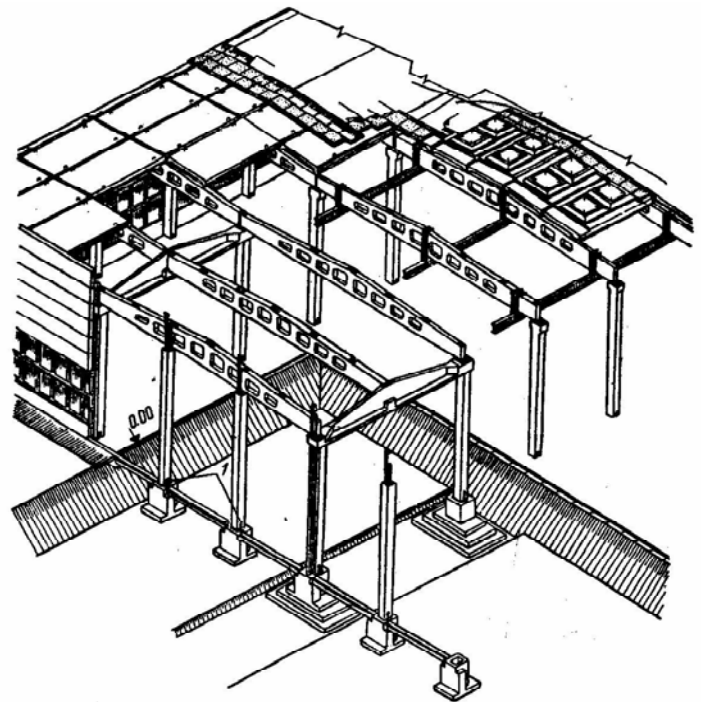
Монтаж перемычек для соединения металлической арматуры зданий.
